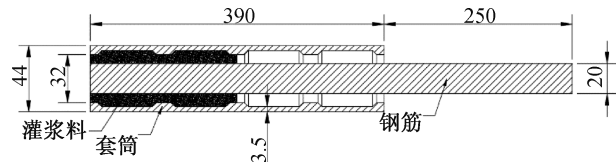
钢筋灌浆套筒灌浆示意图(单位:mm)
